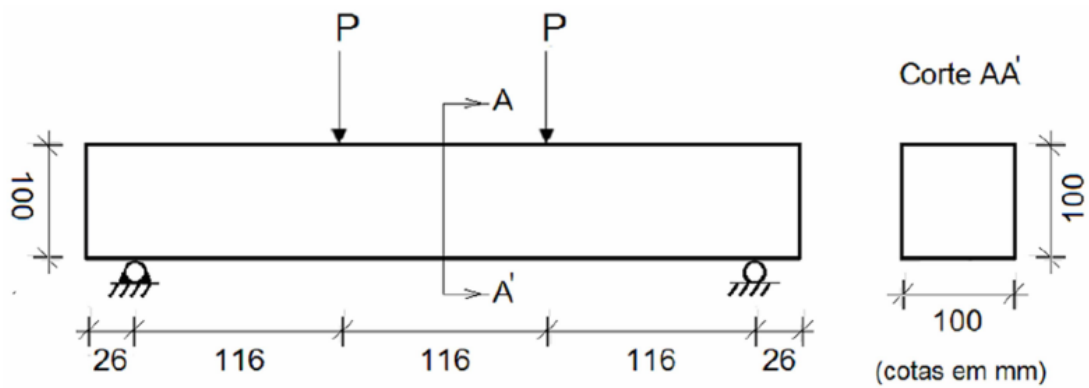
Esquema estrutural das vigas para os ensaios de flexão.
